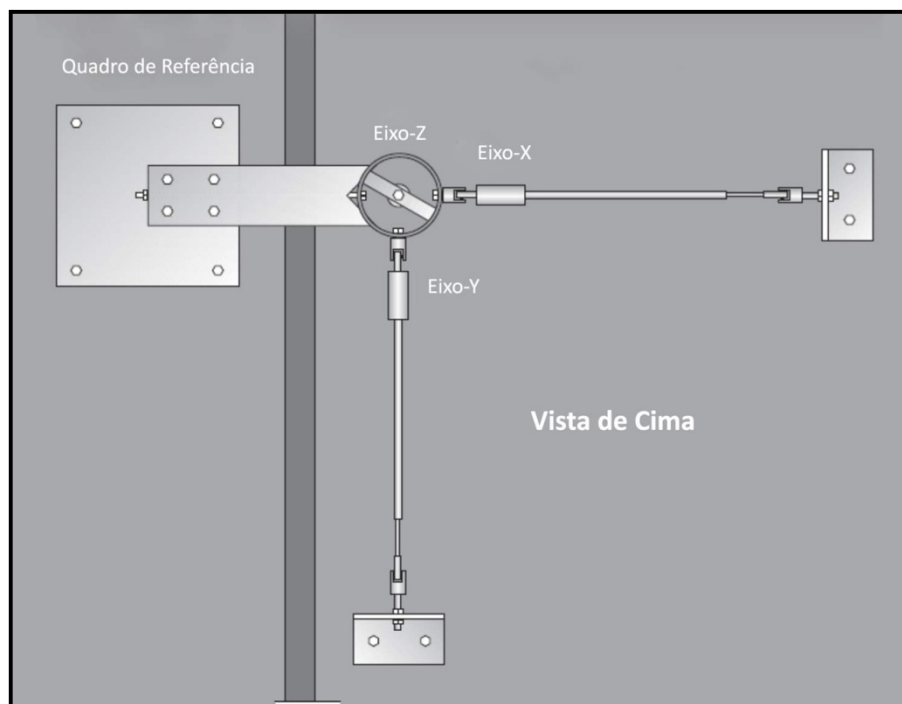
Fissurômetro tridimensional (adaptado de Slope Indicator, 2010).
